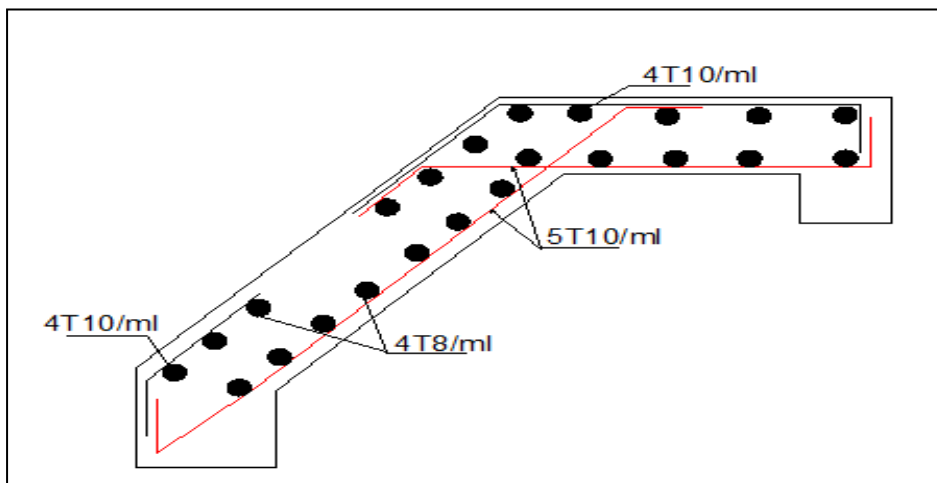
Schéma de ferrailage de l'escalier type II.volée (IetIII).
